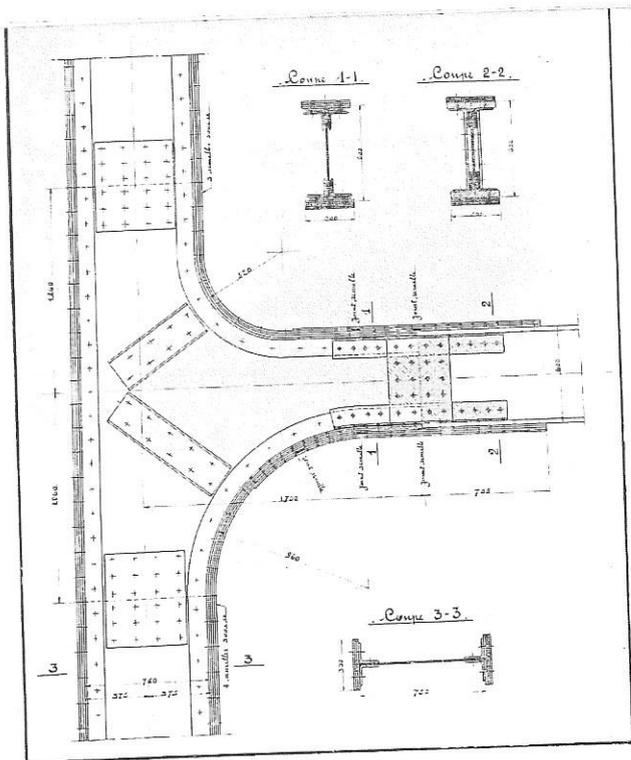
Vue en élévation d'un nœud d'assemblage des poutres aux montants.
